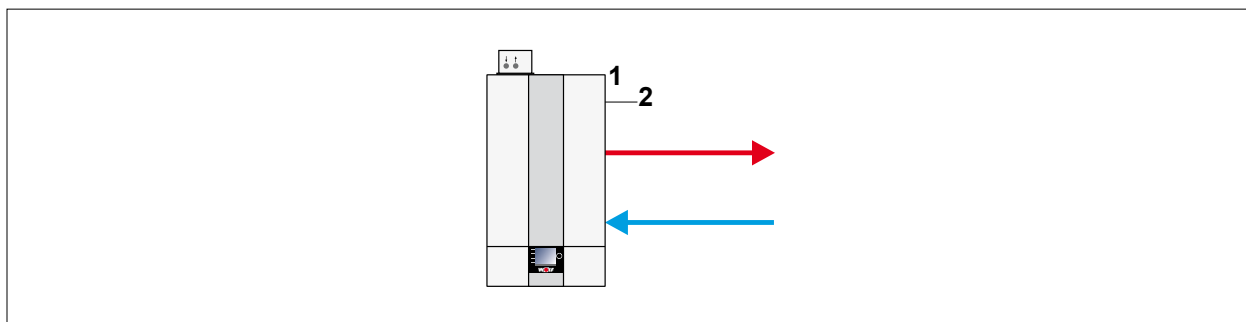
Konfiguracja instalacji 12 – sprzęgło hydrauliczne z czujnikiem
